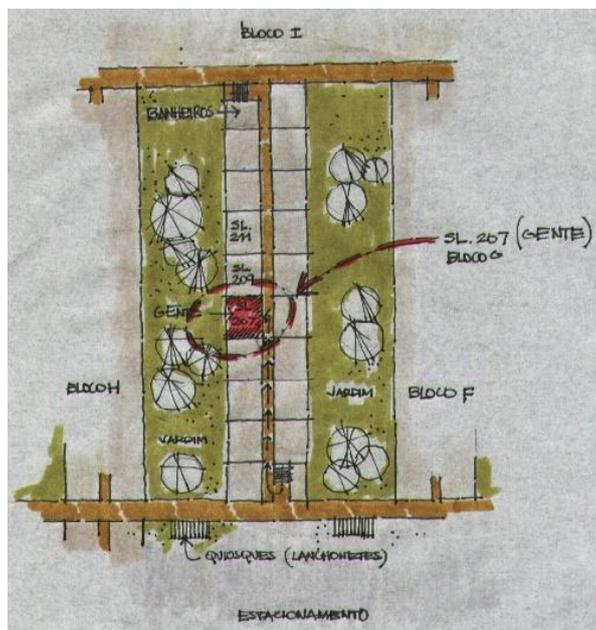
Planta esquemática do segundo pavimento do bloco G: destaque para a sala G 207 – GENTE/COPPE.
